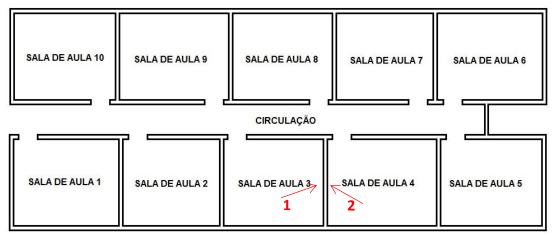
Bloco salas de aula 1 danos na sala 3 e 4 do. 1) fissura vertical na parede sala 3. 2) fissura vertical na parede da sala 4.
